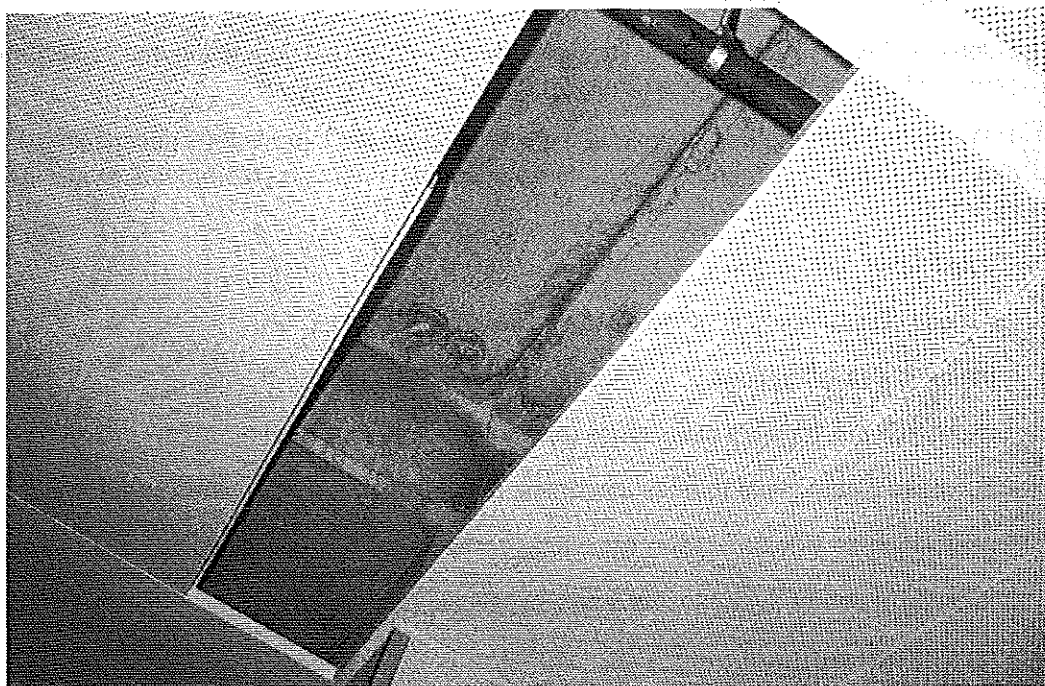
Repérage d'une fuite linéaire du gros œuvre (joint de dalles alvéolées). Traces en sous-face après démontage du panneau de faux-plafond. © J. Putatti
